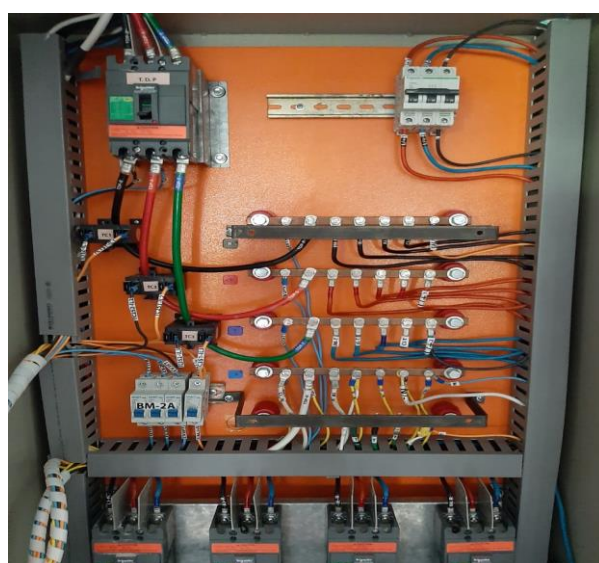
Conexión de cables en las barras R-S-T-N.
